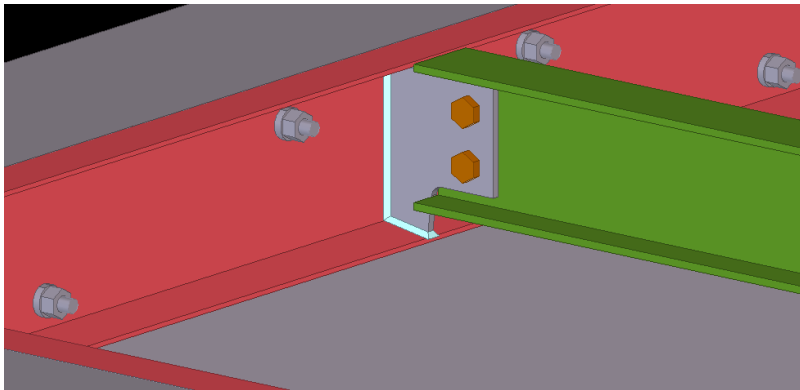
Conexión pernada a cortante entre vigueta IPE y viga C, en la imagen también se observan los anclajes usados para la conexión entre el muro de concreto reforzado con la rejilla.
